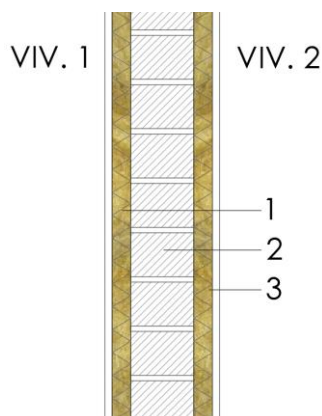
Detalle de tabiquería de división entre viviendas (sección vertical) con lana mineral en Málaga. Fuente: Elaboración propia
